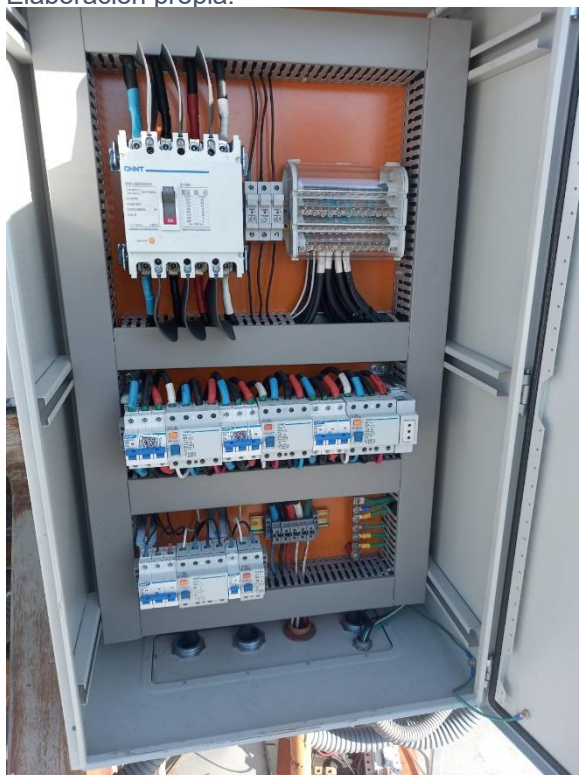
Tablero eléctrico modificado - Fuente: Elaboración propia.
